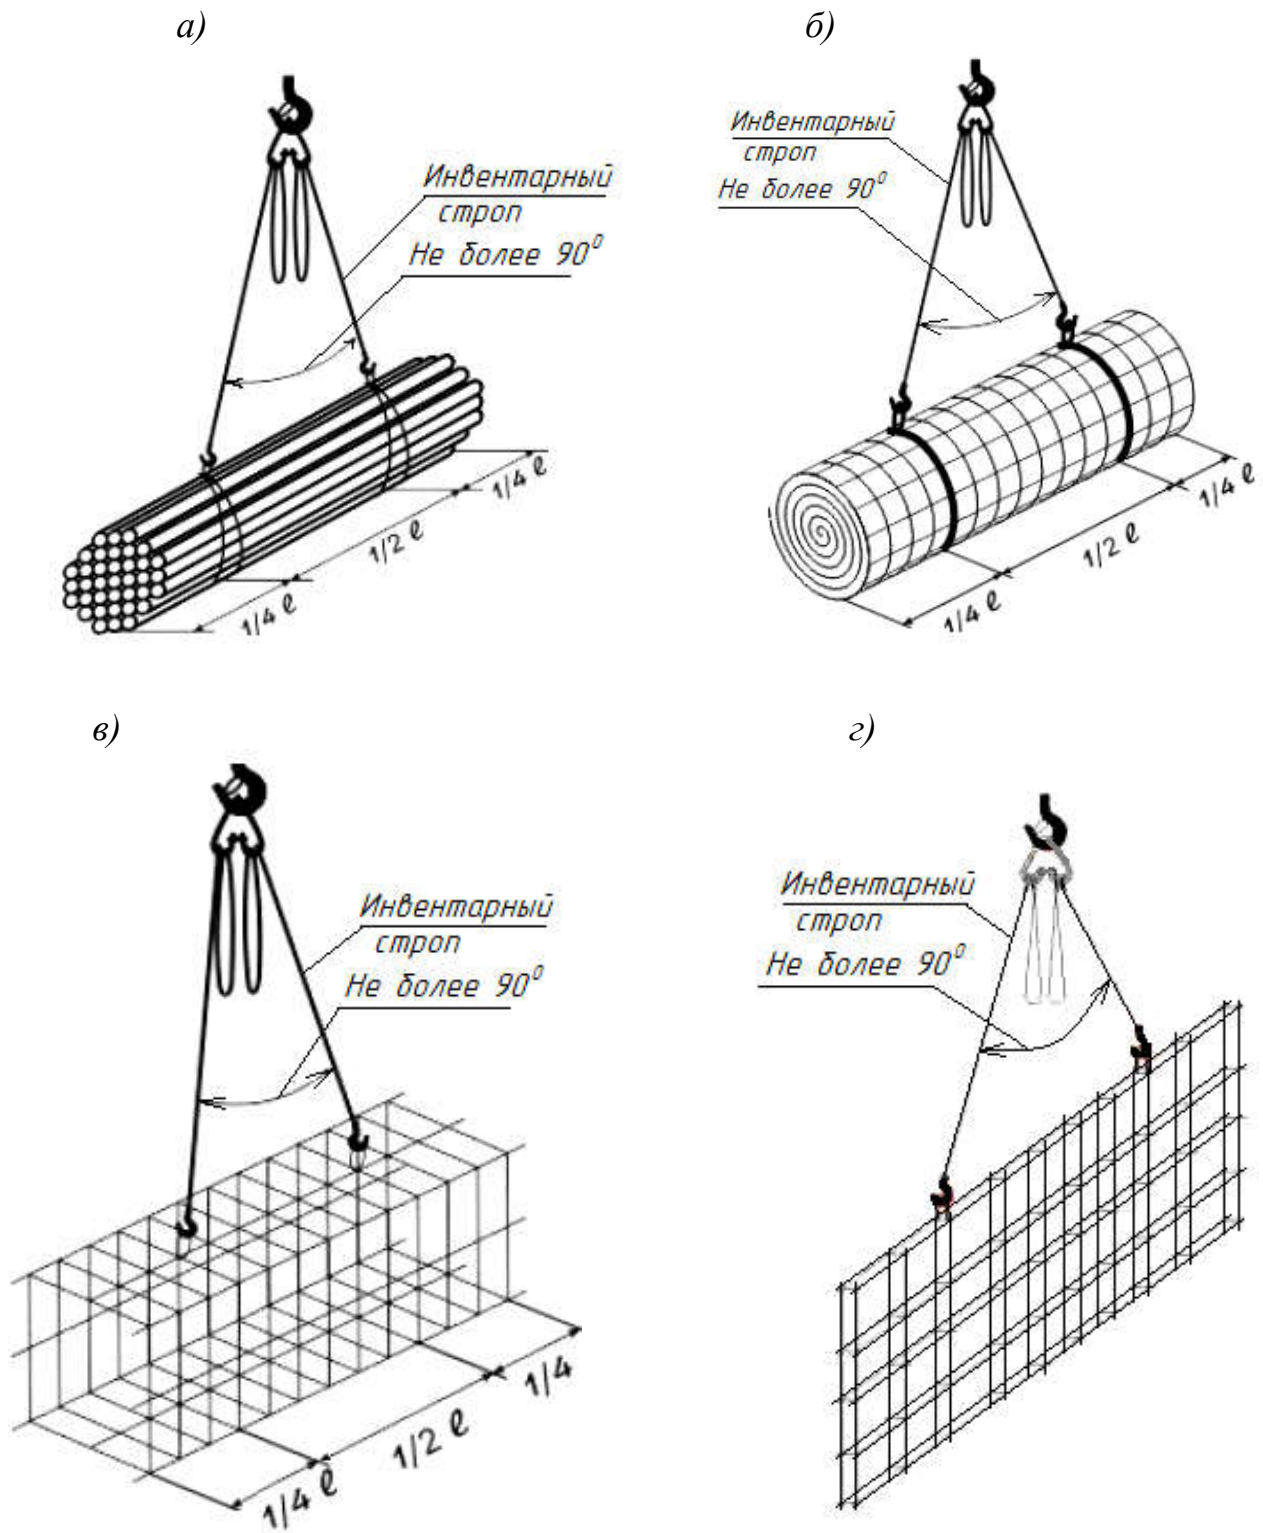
Схемы строповки арматурных стержней длиной менее 6м (а), арматурных сеток в рулонах (б), горизонтальных арматурных каркасов длиной менее 6м (в) длиной менее 6м, арматуры стен (г)
